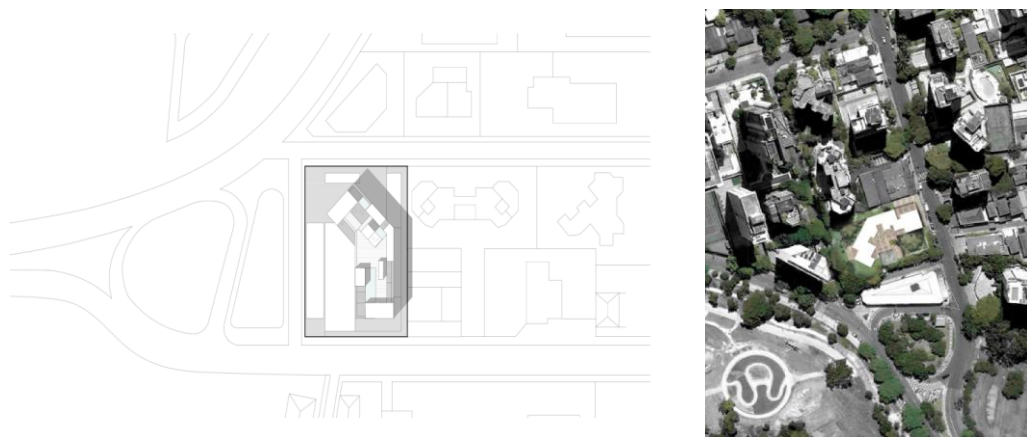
ERC ARTS ITAÍM planta de implantação.
